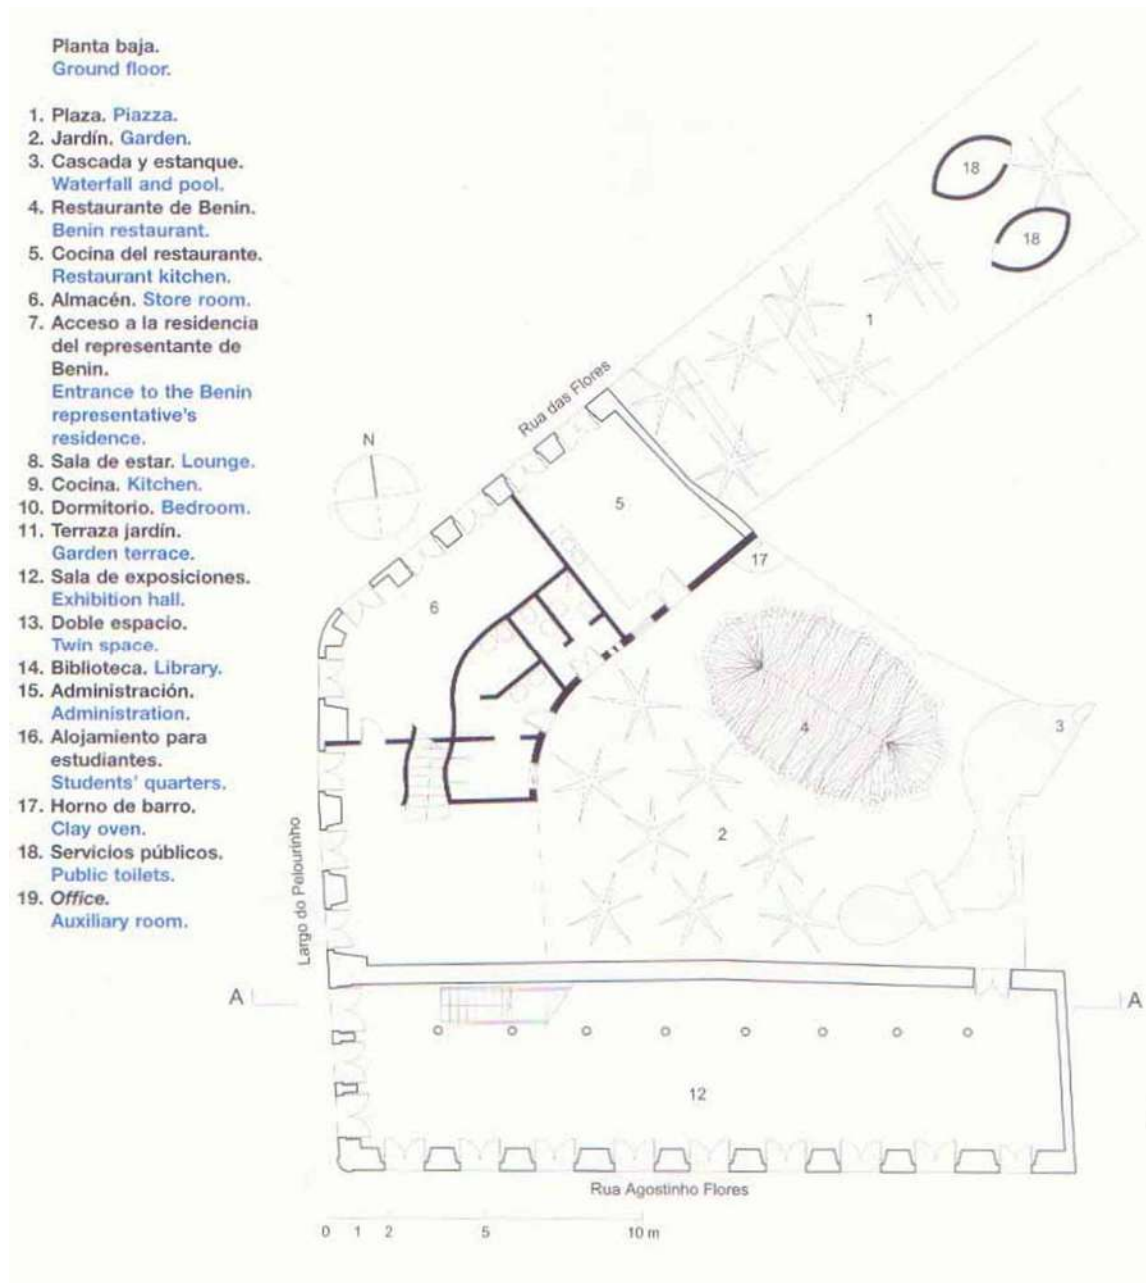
(ao lado) – Implantação da Casa do Benin, com proposta de intervenção.
